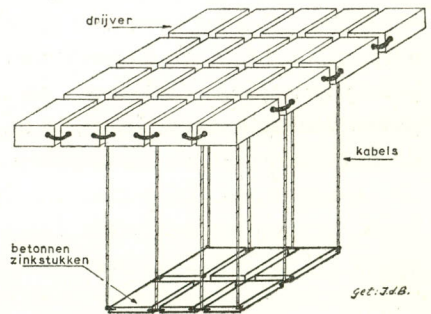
Schets van een betonnen zinkstuk met houten drijvers.
